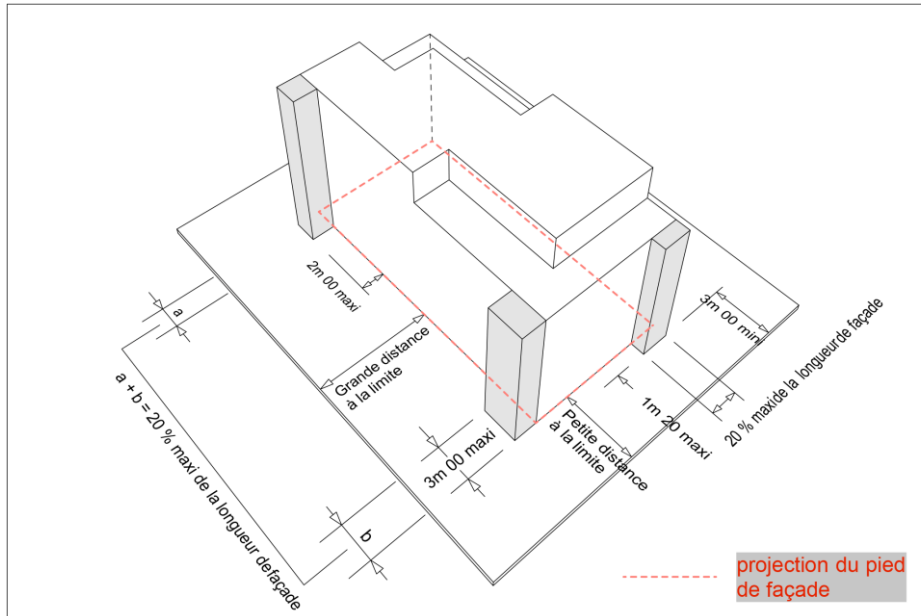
saillies fermées (rouge : modifications par rapport au croquis existant)
